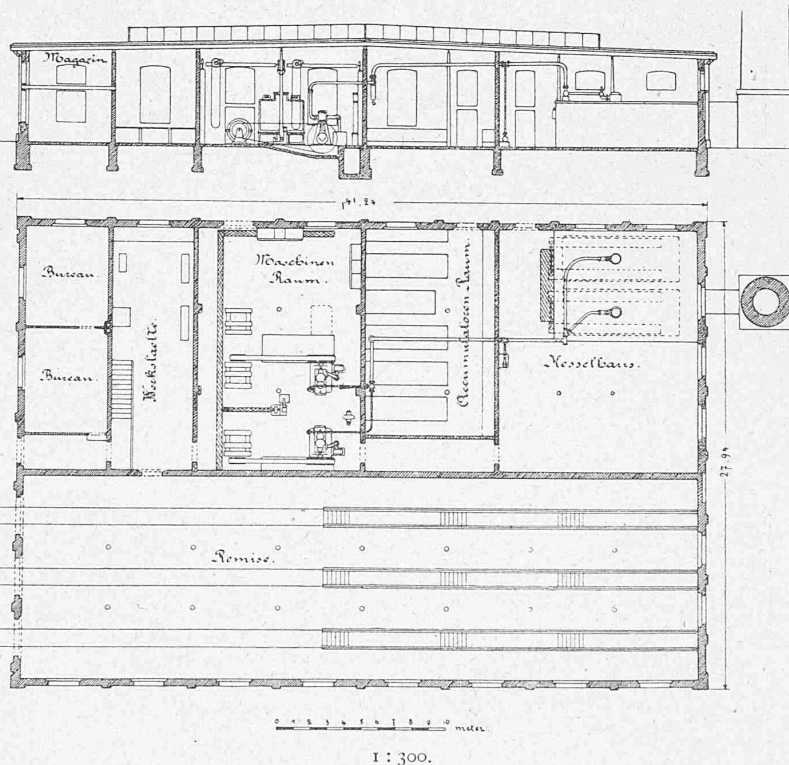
und 4. Schnitt und Grundriss.
